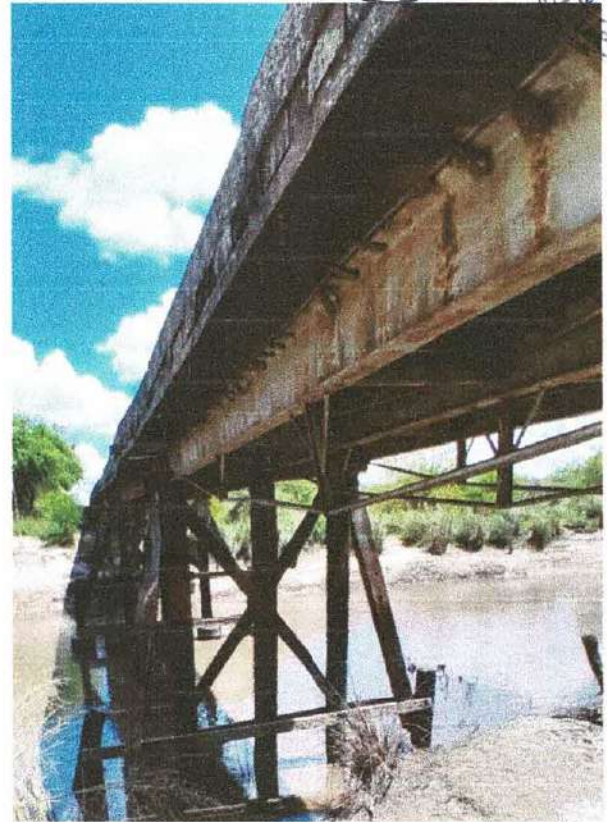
Estado actual estructuras sobre Arroyo El Rey
